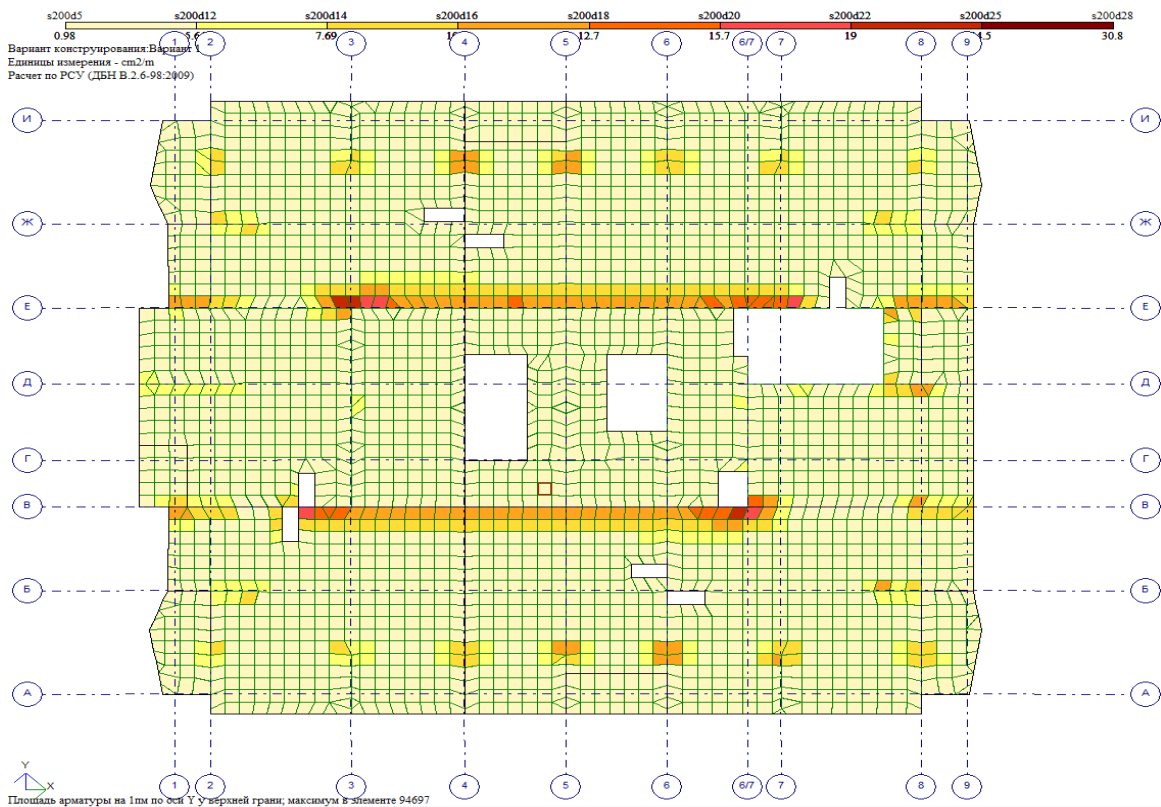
Перекрыття на відмітці +36.00 м. Верхня арматура по Y
